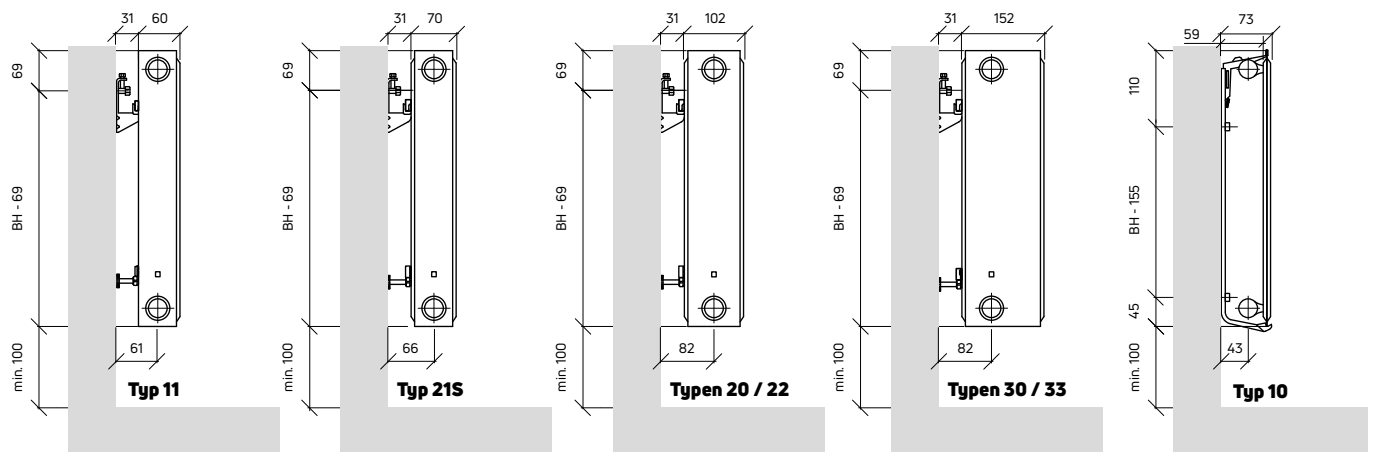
Montage Maße für Compact mit Befestigungslaschen
